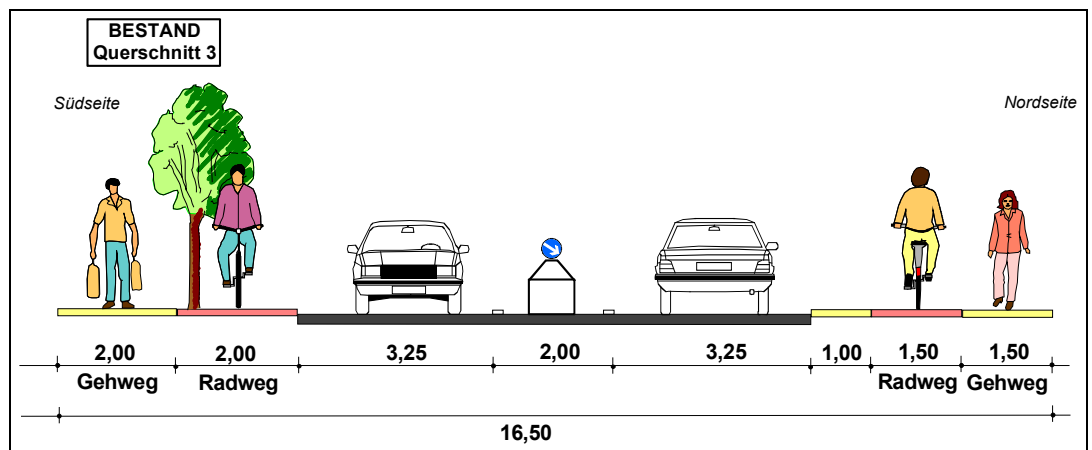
Elsässer Straße – Bestand Abschnitt 3 (Q 3)
